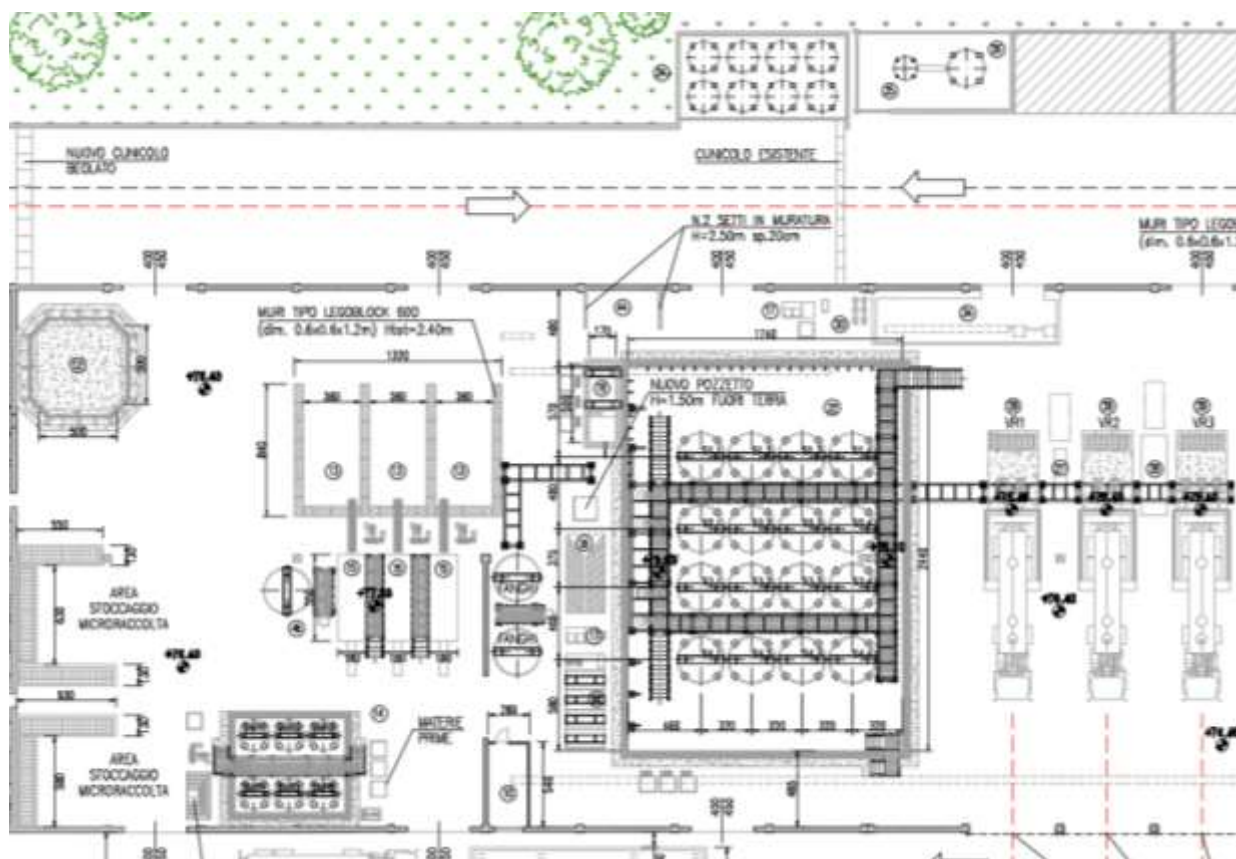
vista planimetrica impianto trattamento chimico/fisico
